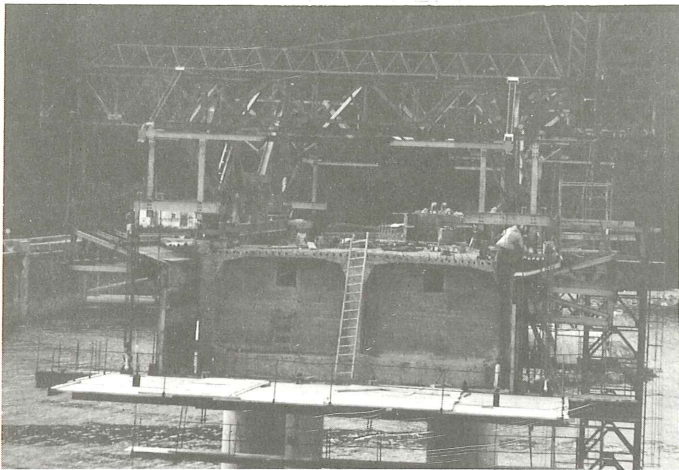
Zona entre pilas: Sección transversal y traviesa.
